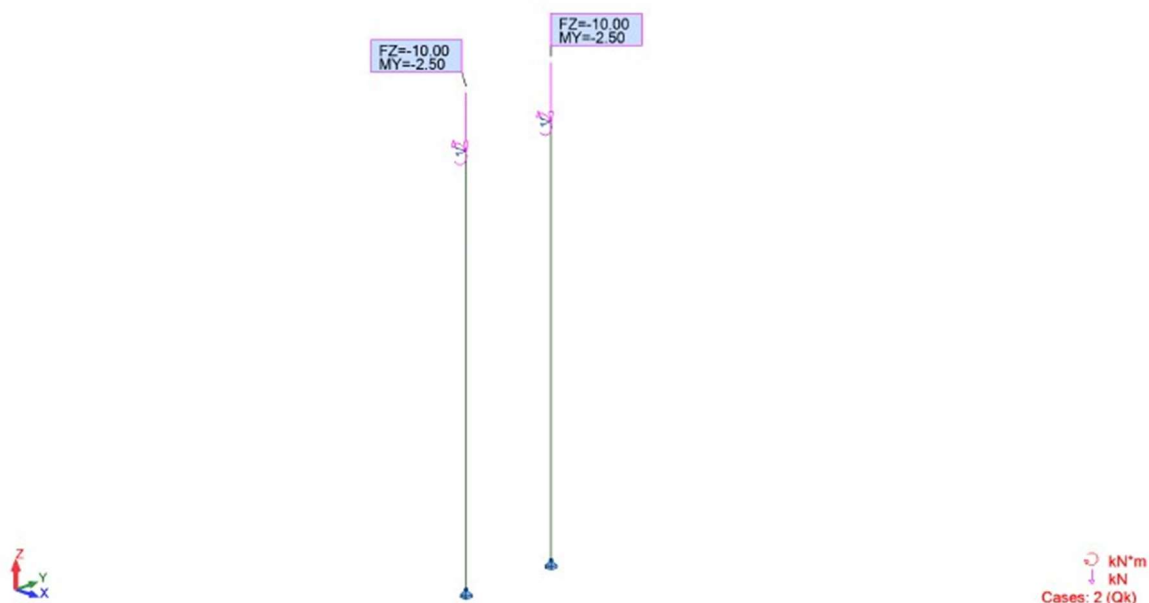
Situações de cargas consideradas para verificação da segurança das escoras – Musée Carnavalet
